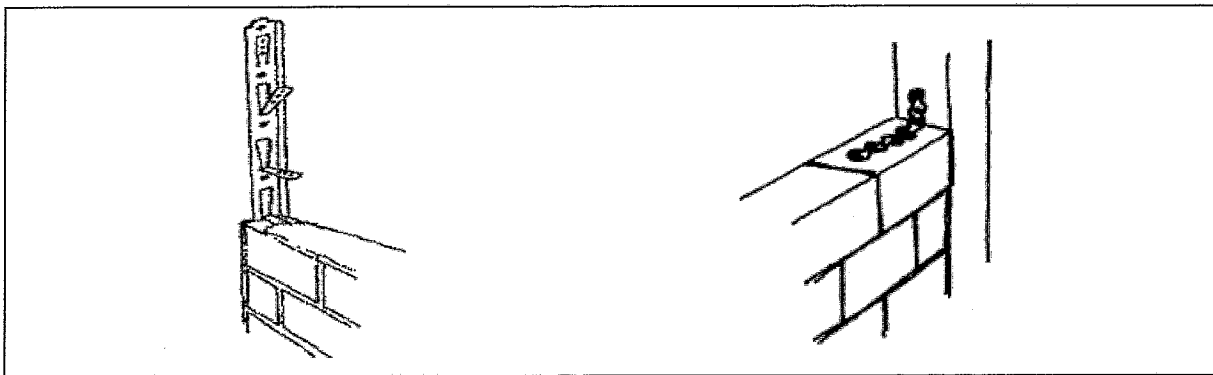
Pormenor de dois tipos de perfis para ligações verticais [33]
